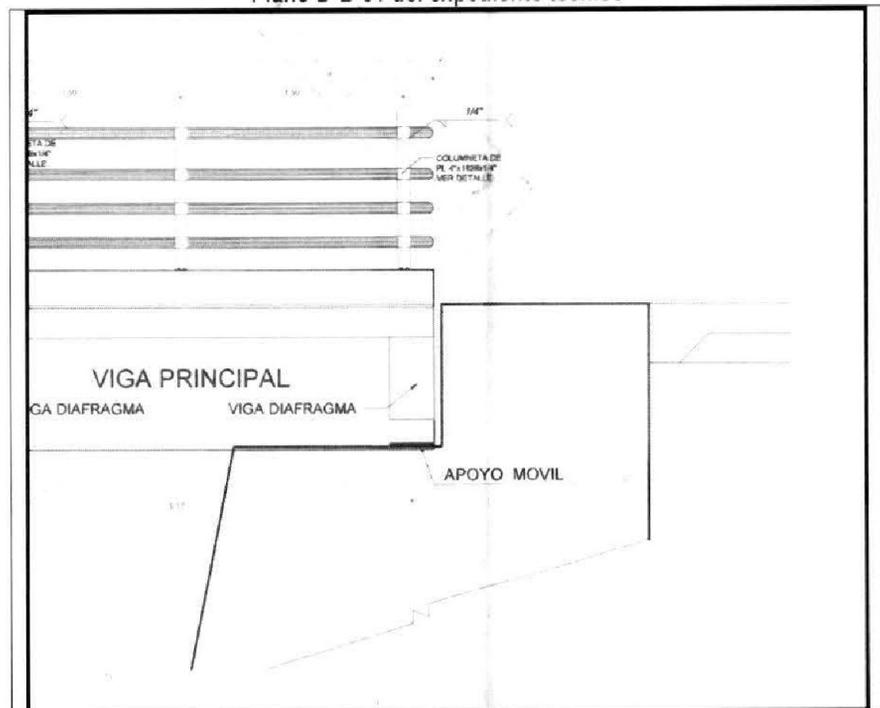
En la imagen precedente, correspondiente al plano D-B-01 del expediente técnico, se verifica que la viga principal (super - estructura), se encuentra completamente apoyado sobre la cajuela del estribo (sub - estructura).
